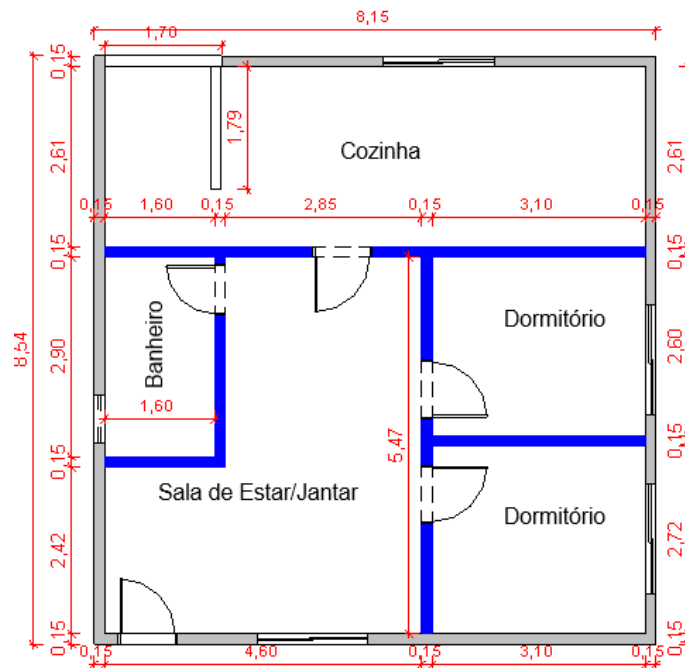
Projeto arquitetônico para levantamento das dimensões
